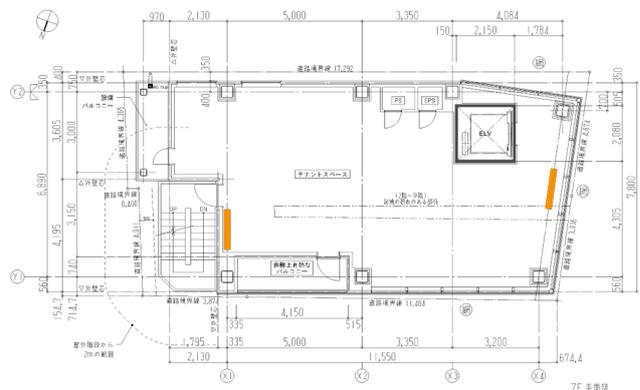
有孔 CLT 制振壁 配置図(7 階)
